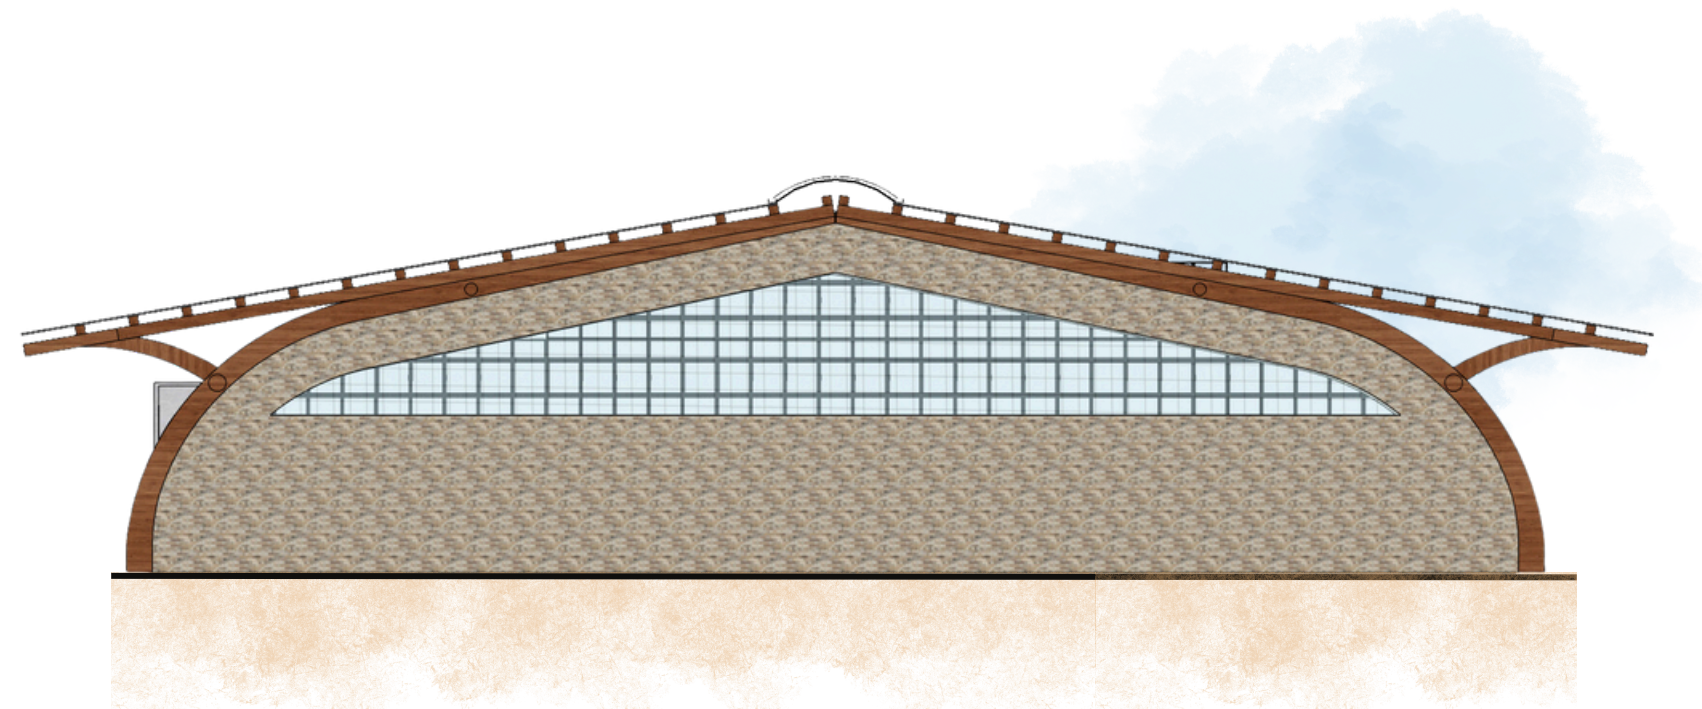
Elevação 01 picadeiro provas / Fonte: Elaborado pela autora em 2024
